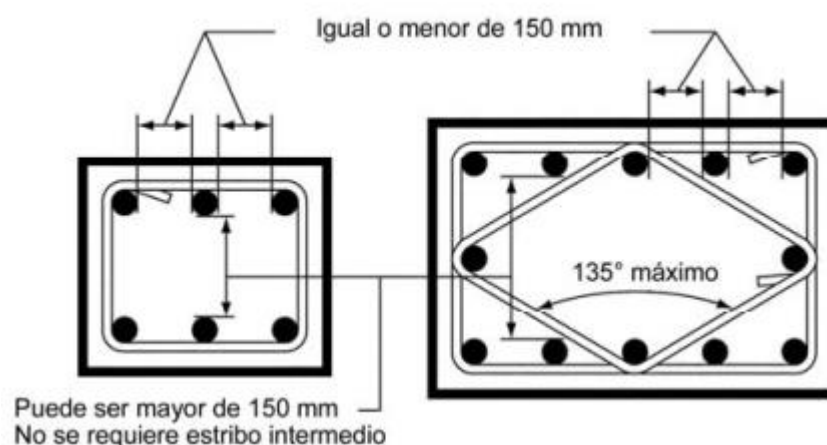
Croquis medidas entre barras de columna apoyada lateralmente
